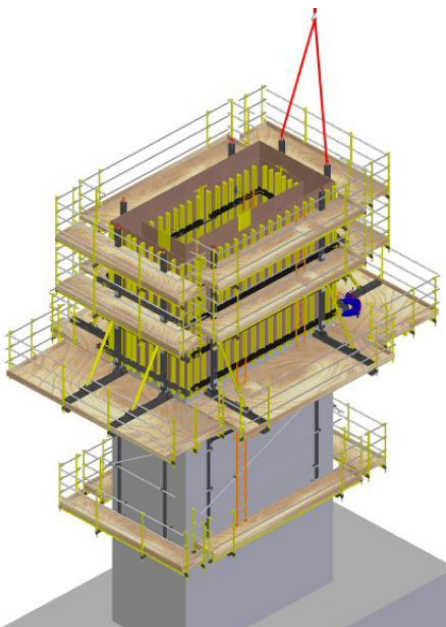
al. Izado y colocación del panel final para cerrar al encofrado exterior. Recuperado de: Ulma Construction, *Instrucción técnica de montaje*.
